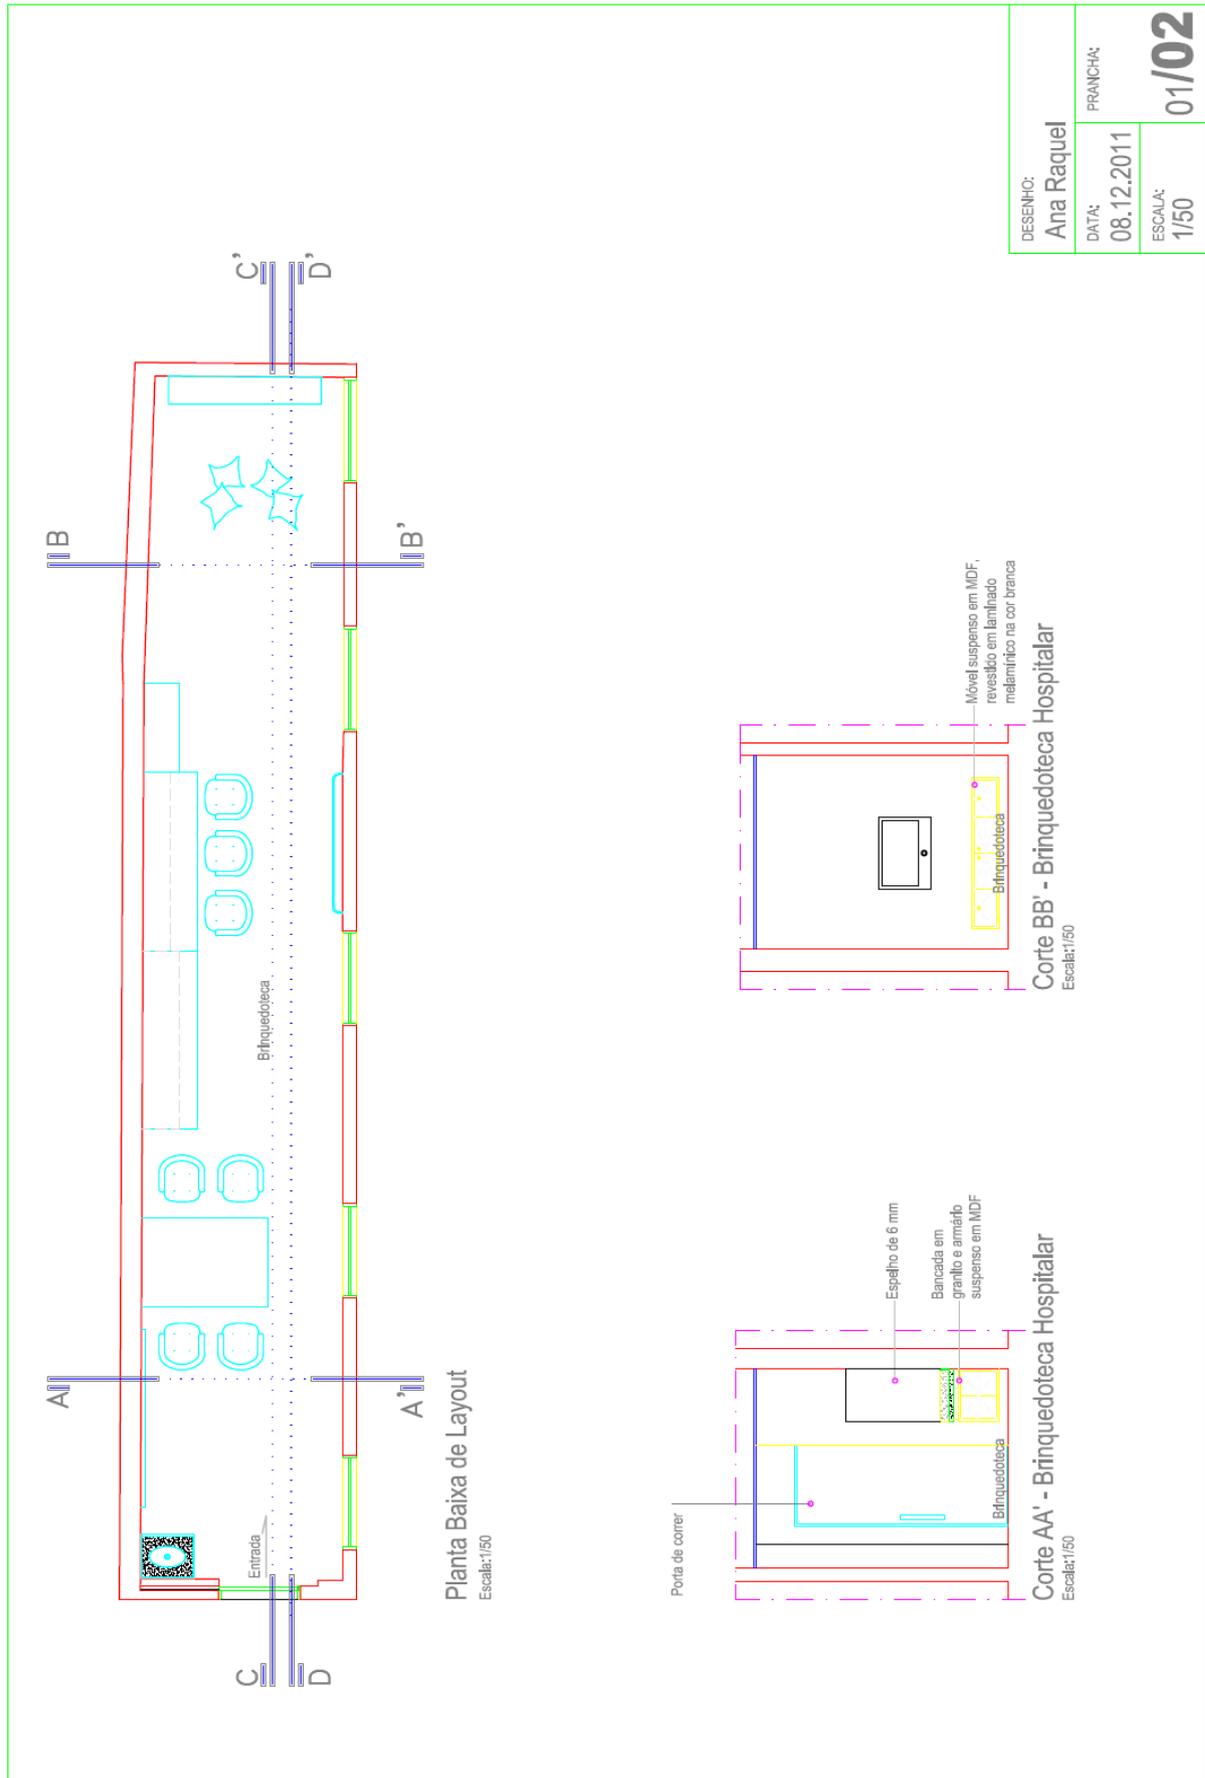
Planta baixa de *layout* e cortes AA' e BB'
